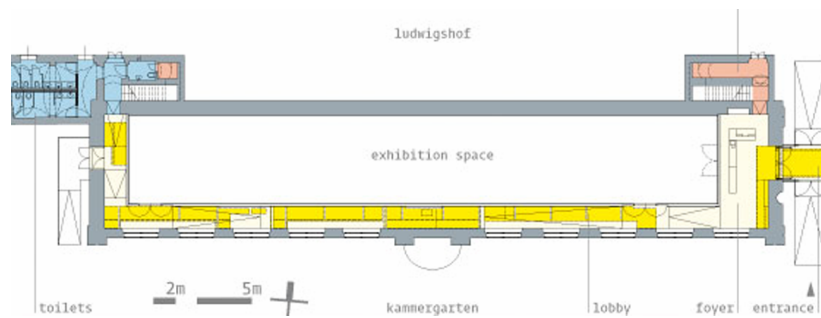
Susanne Zottl, Orangerie Belvedere Wien, 2007, Grundriss nach Umbau.
